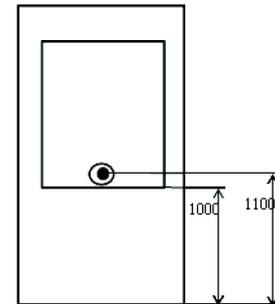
f — Türblatt mit Fenster oberhalb 1,00 m
